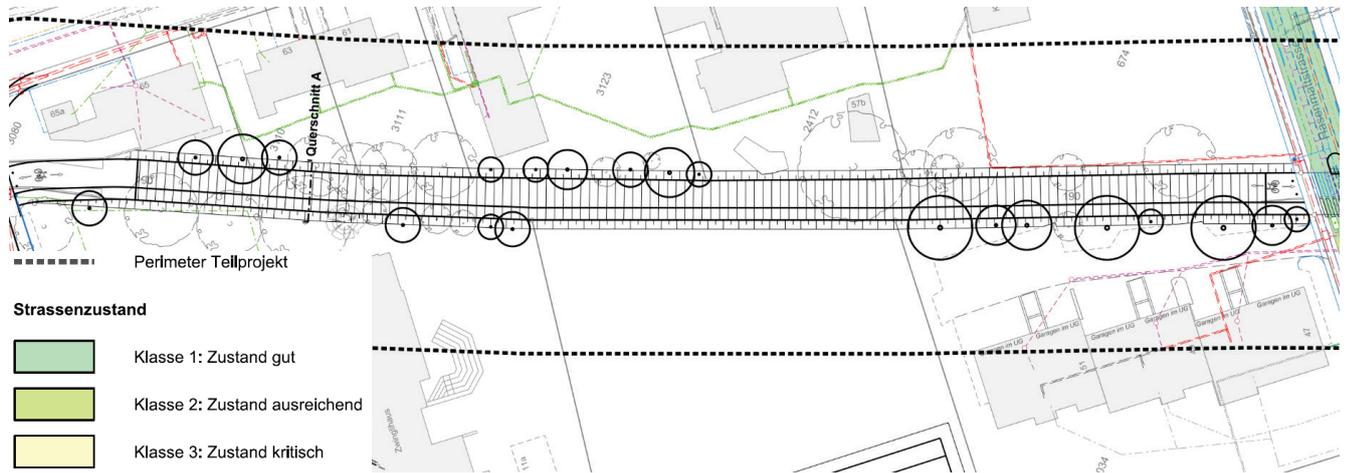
Ausschnitt Bestvariante Abschnitt Fuss- und Veloverkehrsachse (siehe auch Massnahmenplan Werkleitungen, Anhang 3)
